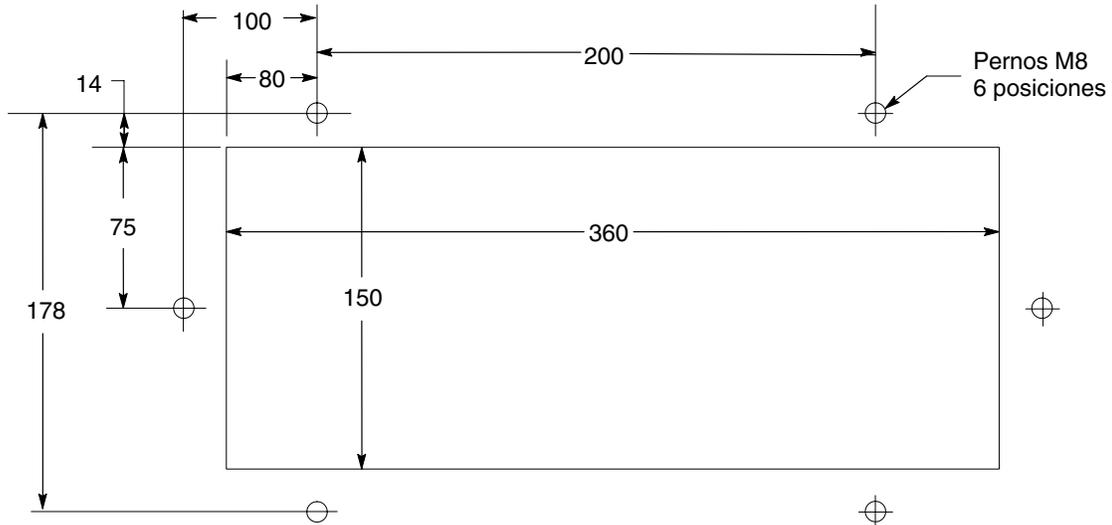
Dimensiones de la conexión del conducto de extracción (todas las dimensiones aparecen en milímetros)
